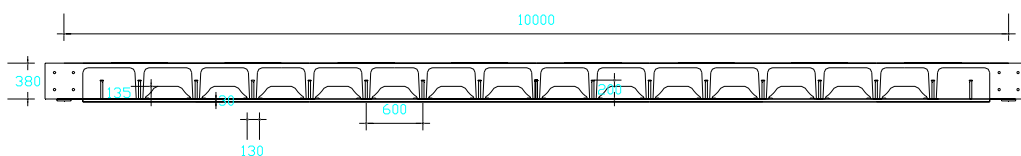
Coupe longitudinale - solution 10m - Dalle BFUP gaufree-échancrée et semelles en acier
